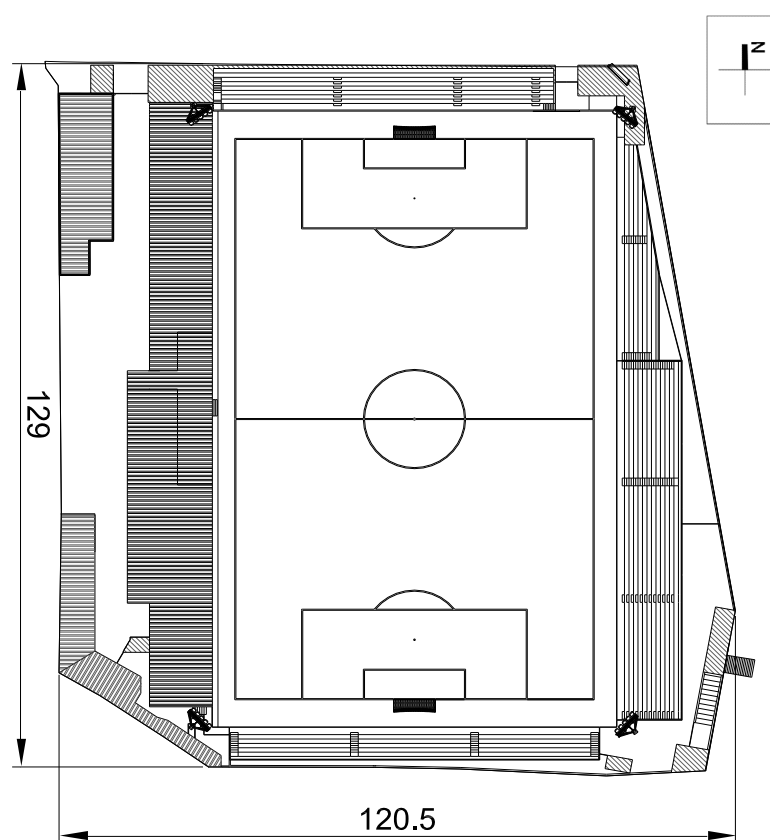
Planta do estádio Marcolino de Castro (unidades em [m]) (Adaptado)
